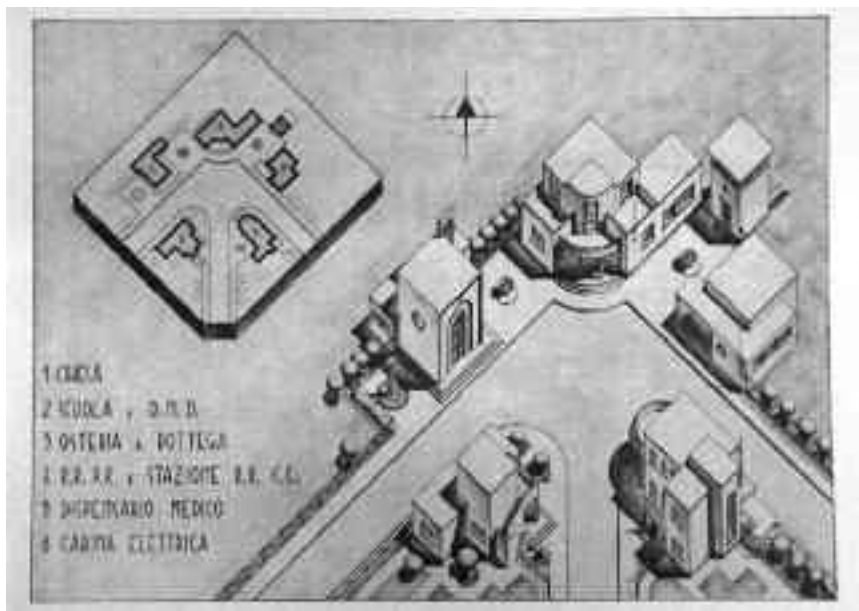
Centro rurale di tipo minimo, Planimetria e assonometria (Mangano, 1937).
